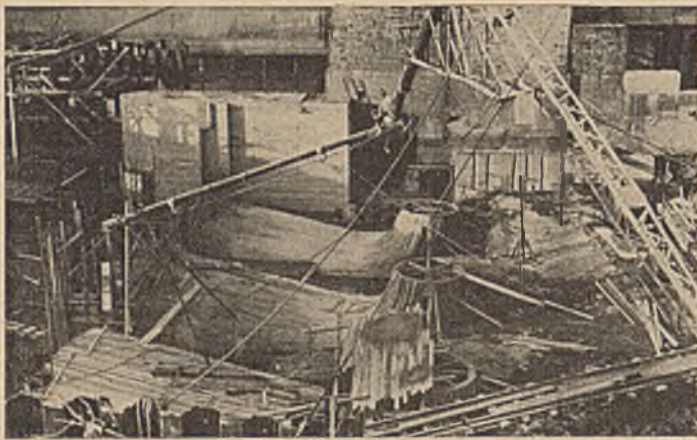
Blick in die Krafthausbaugrube. Schalung der Saugkrümmer. Gießen der Saugrohrwandungen.
